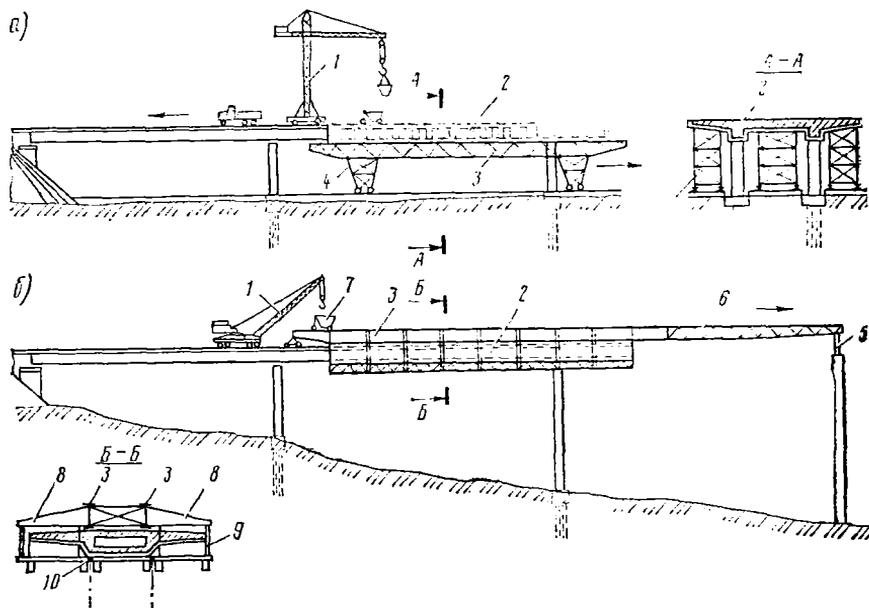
Перемещающиеся подмости для бетонирования:
